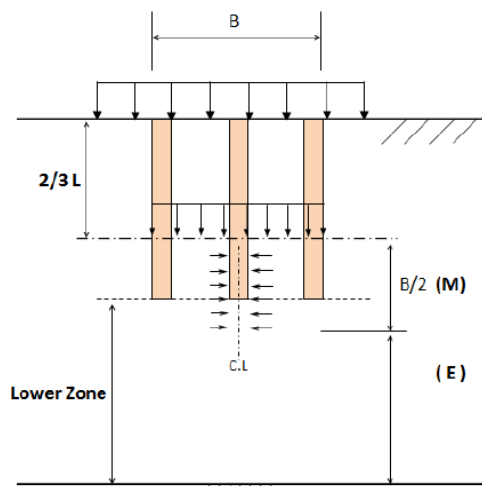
Distribuição de tensões na zona inferior às colunas de pedra – modelo para cálculo por meio da aplicação de método de elementos finitos (BORDEN, 2010)
